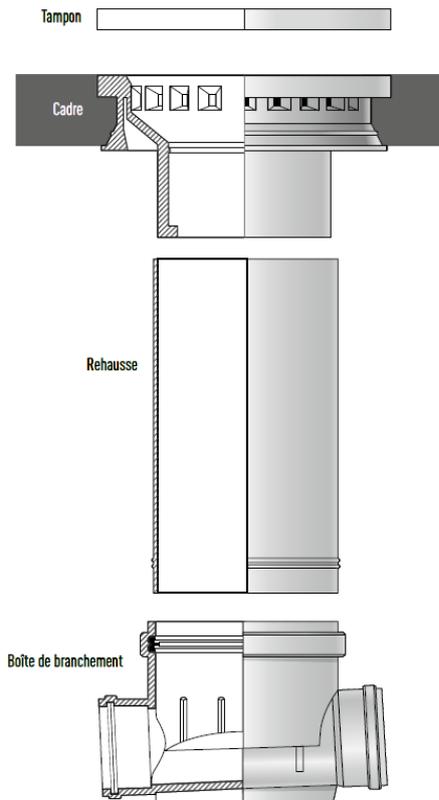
BOITE DE BRANCHEMENT TYPE TABOURET
